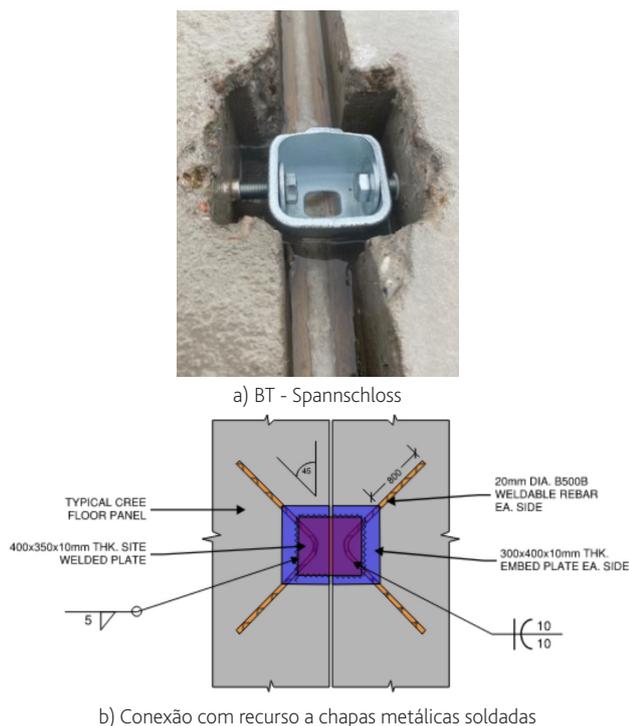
Outros tipos de conectores de corte entre painéis de laje CREE
